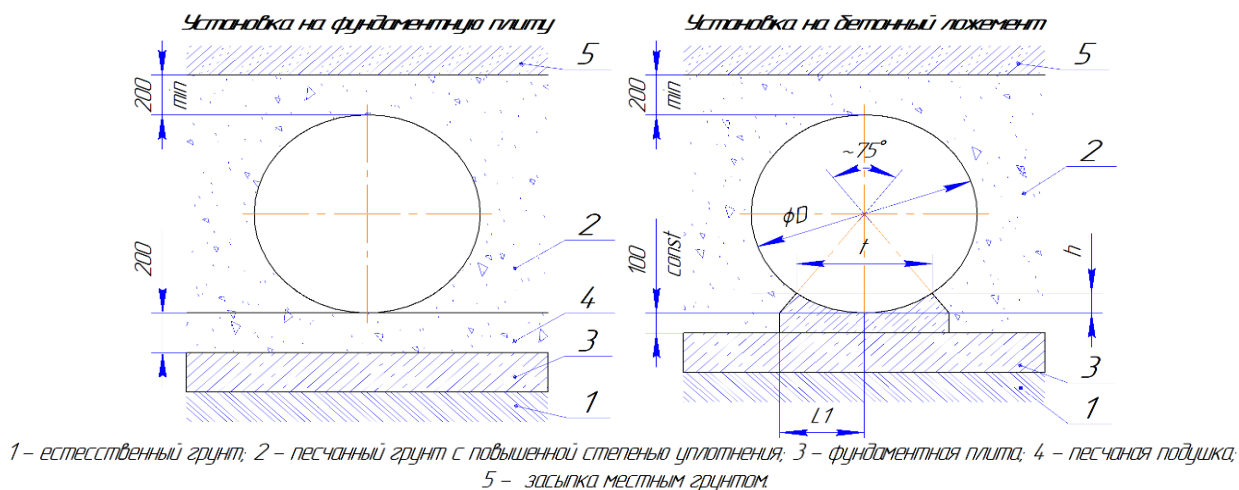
монтаж горизонтального корпуса на фундаментную плиту
